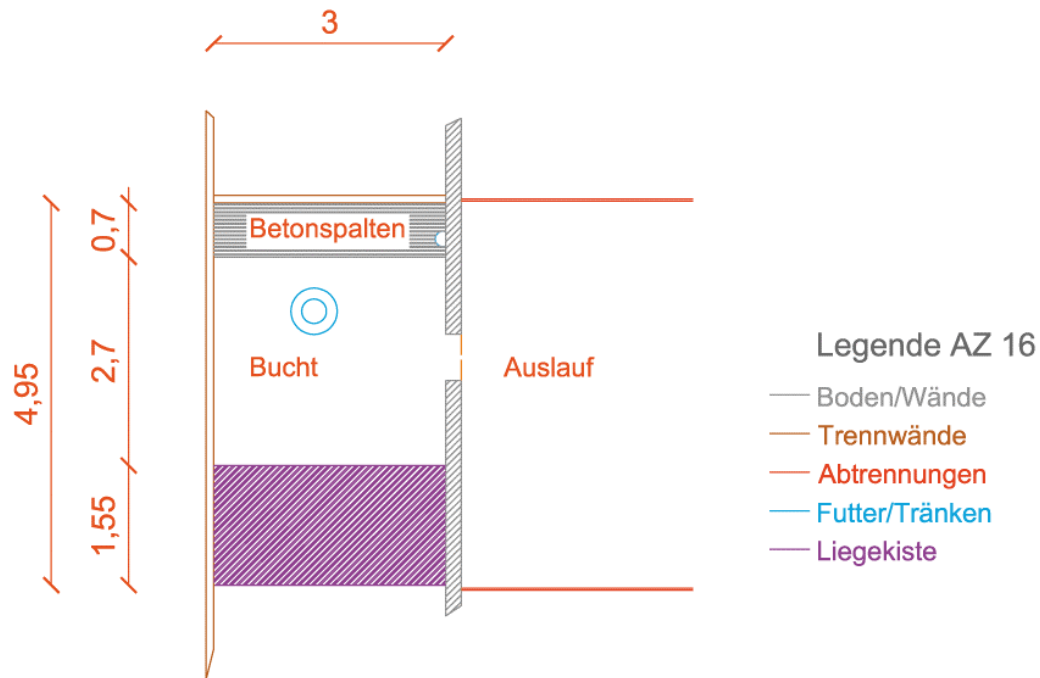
AZ16: Grundriss Aufzuchtstall mit Auslauf (eig. Abb.)
